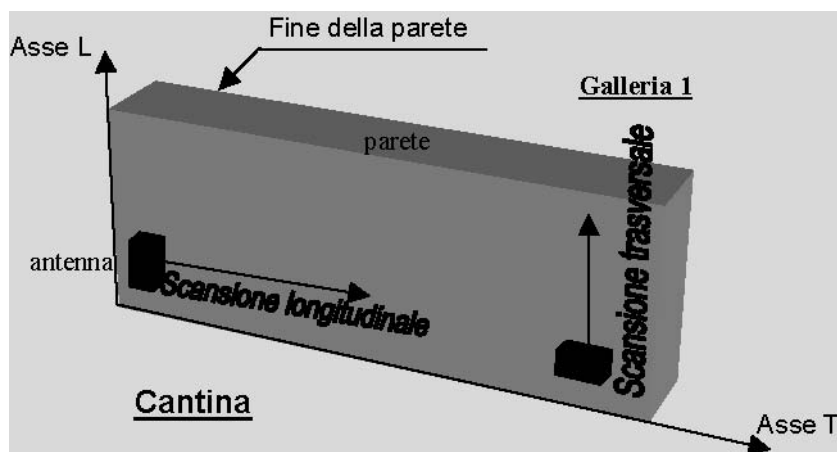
Schema di acquisizione radar, realizzata sulla parete della Cantina confinante con la Galleria 1
